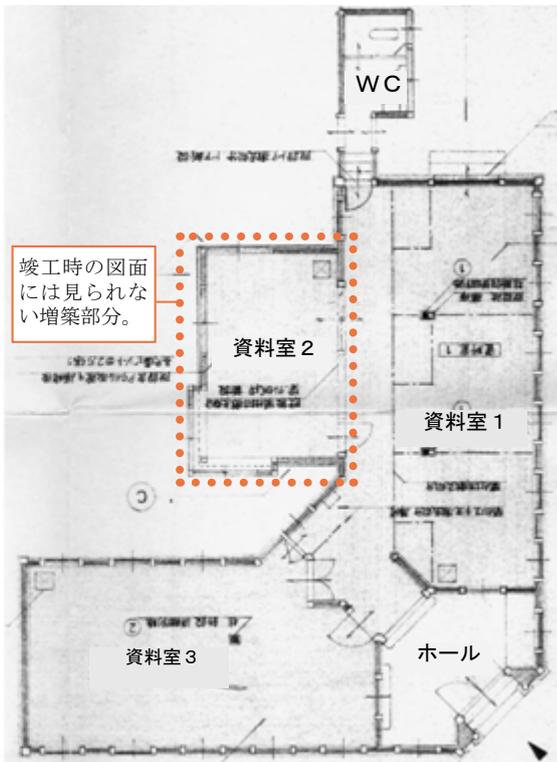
昭和 61 年 (1986) 改修時平面図 S=1:200
